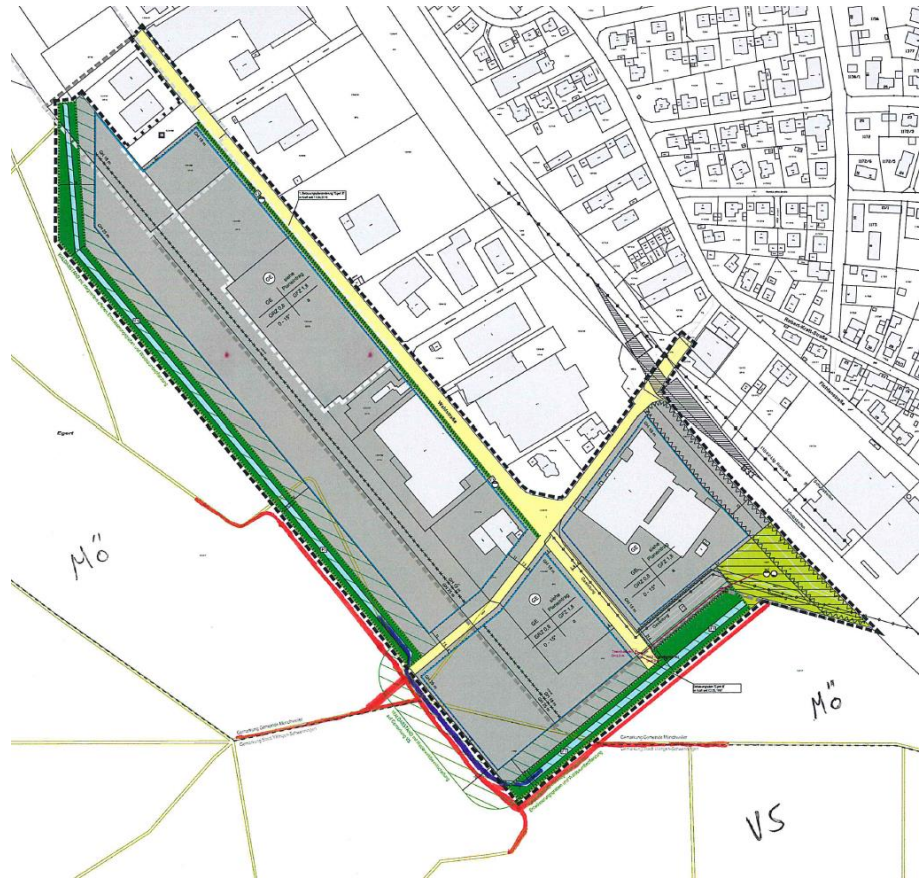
Geplante Anbindung der Waldwege im Anschluss an das Bebauungsplangebiet „Egert IV“. Geplante Wege rot dargestellt (Quelle: Gemeinde Mönchweiler, E-Mail vom 24.03.2021)
